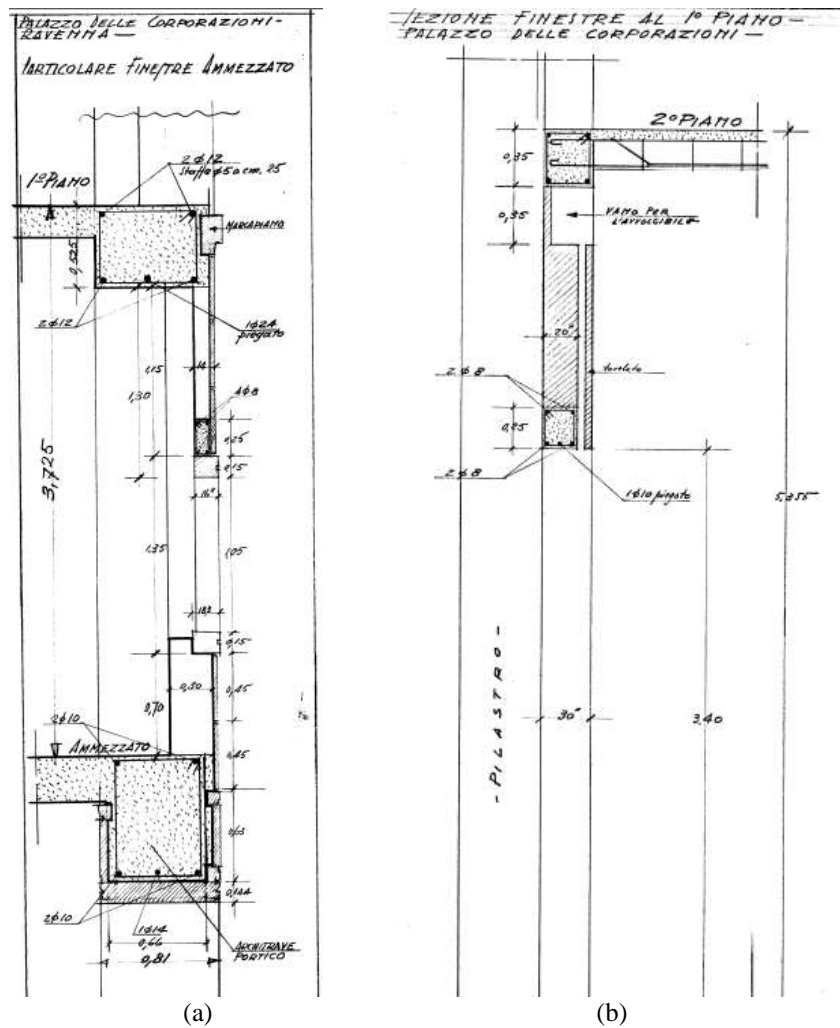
Particolare delle finestre ai piani 1° e 2° con dettaglio delle architravi e dei cordoli di piano; progetto preliminare.
